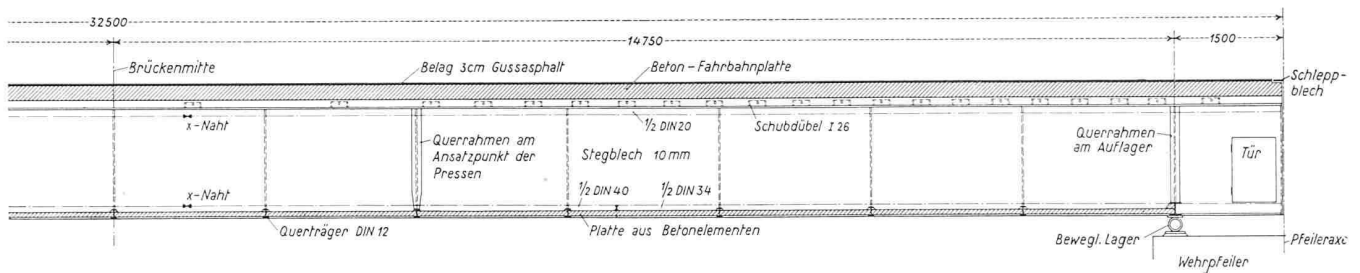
Wehrbrücke Birsfelden, Längsschnitt 1:100
